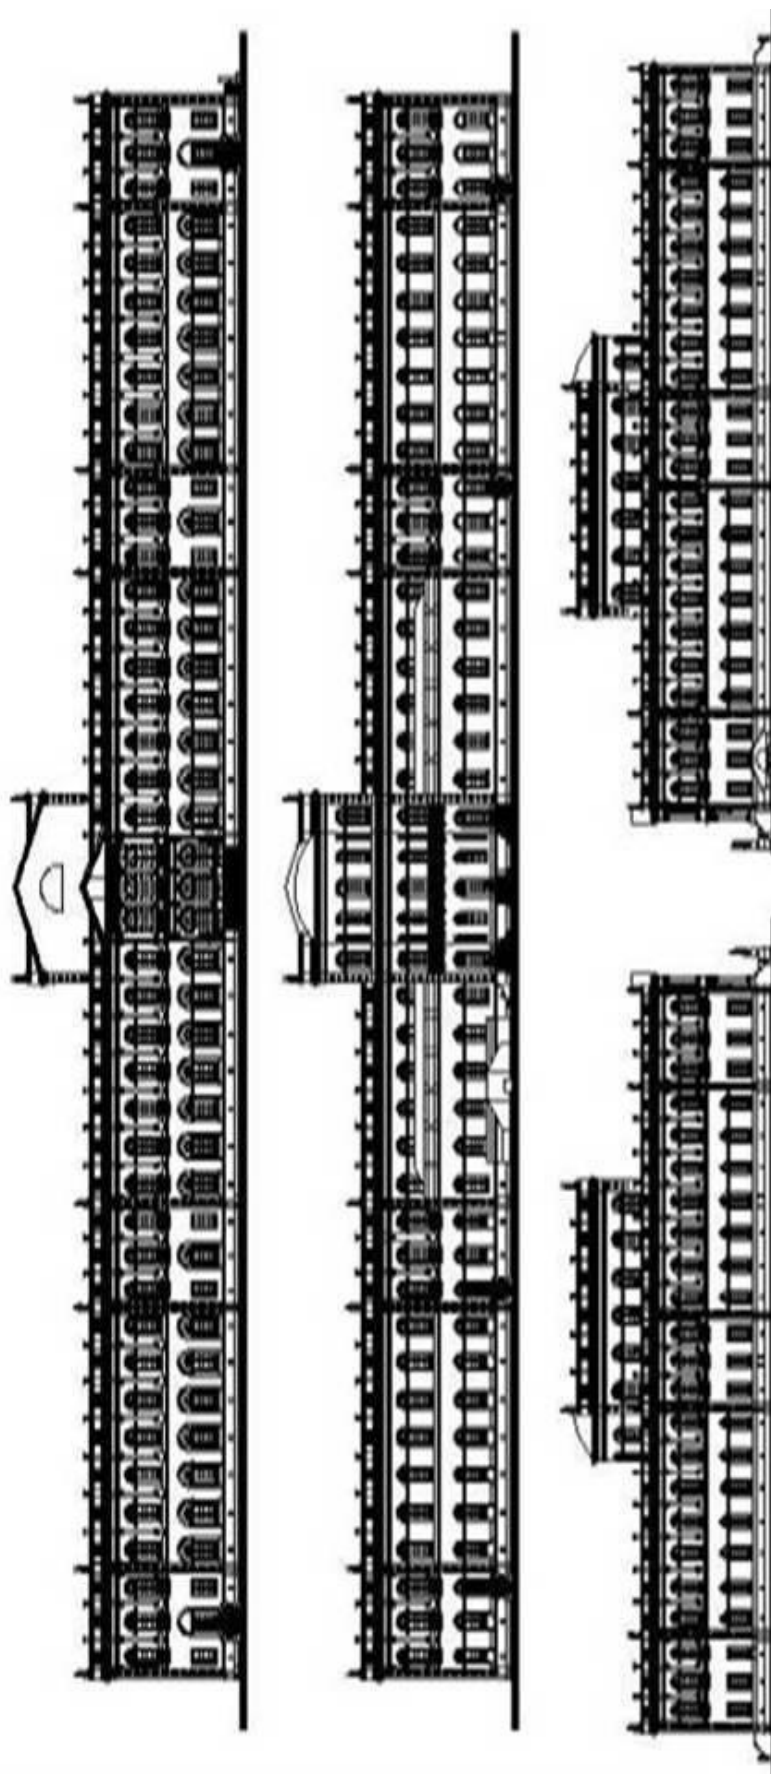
Fachadas do Palácio Universitário. De cima para baixo: fachada principal (nordeste), fachada posterior, fachadas laterais. Fonte: Hoirisch, 2007.
